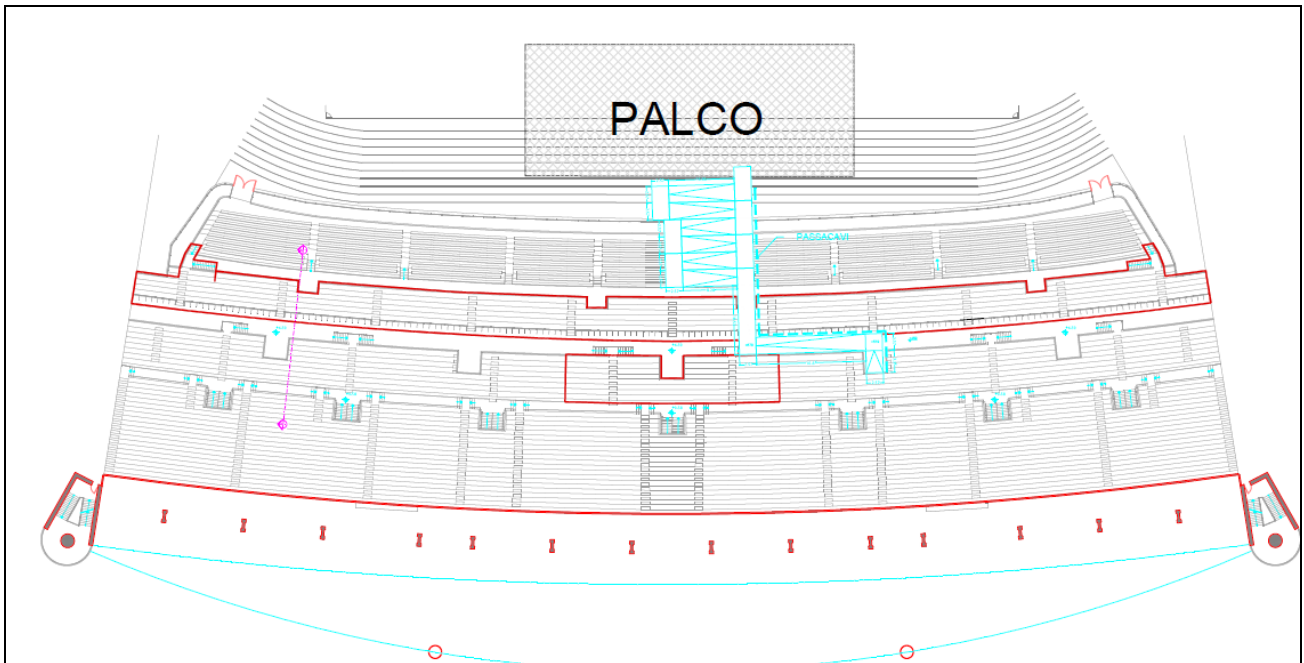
Planimetria con rampa di servizio presso la Tribuna Tevere
